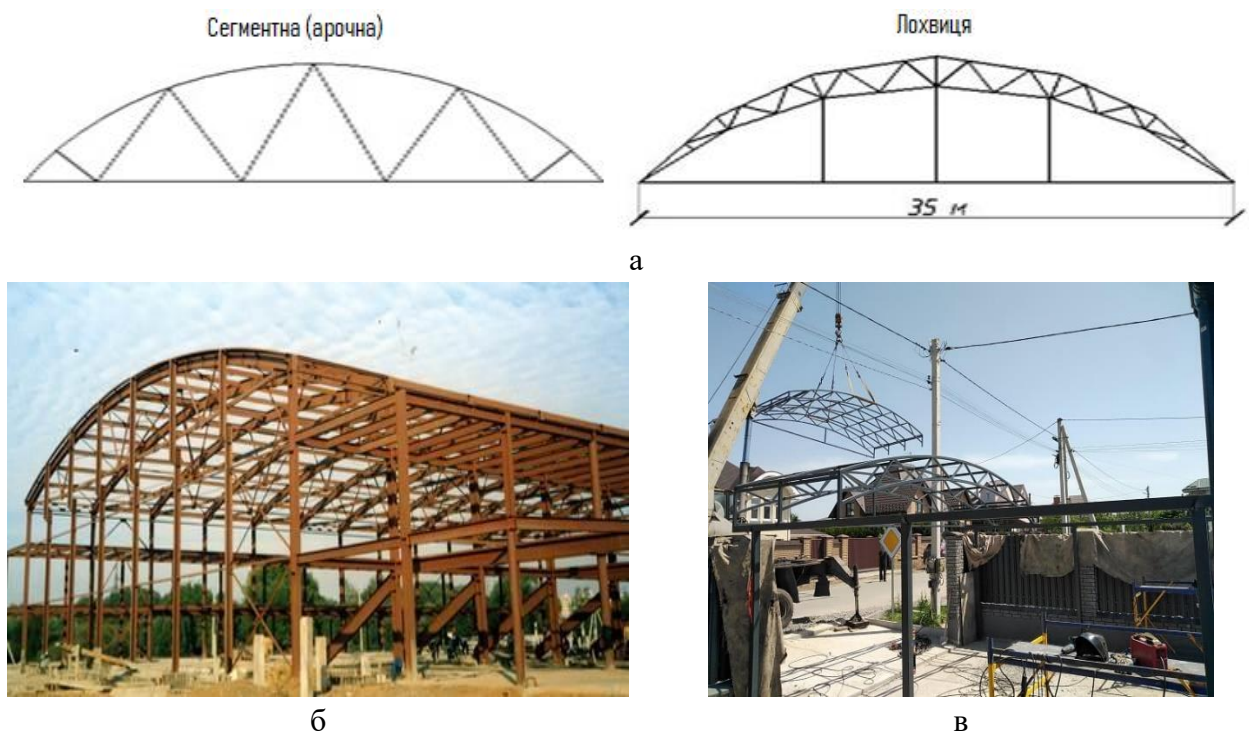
Сегментні ферми: а – схеми ферми; б – збудоване покриття з сегментними фермами; в – монтаж ферми
